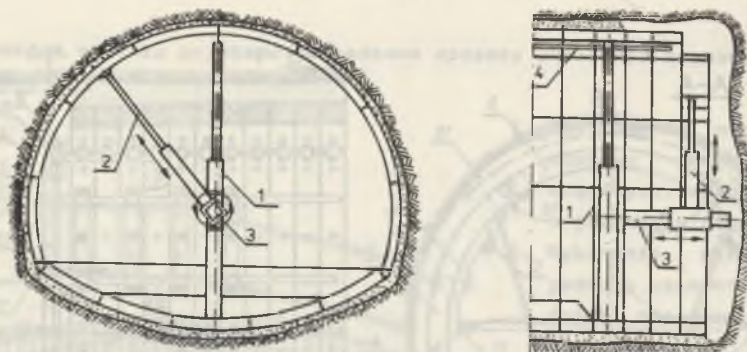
Wykonawstwo segmentowej obudowy żelbetowej złożonej z jednakowych pierścieni przy jednym segmentcie stropowym
